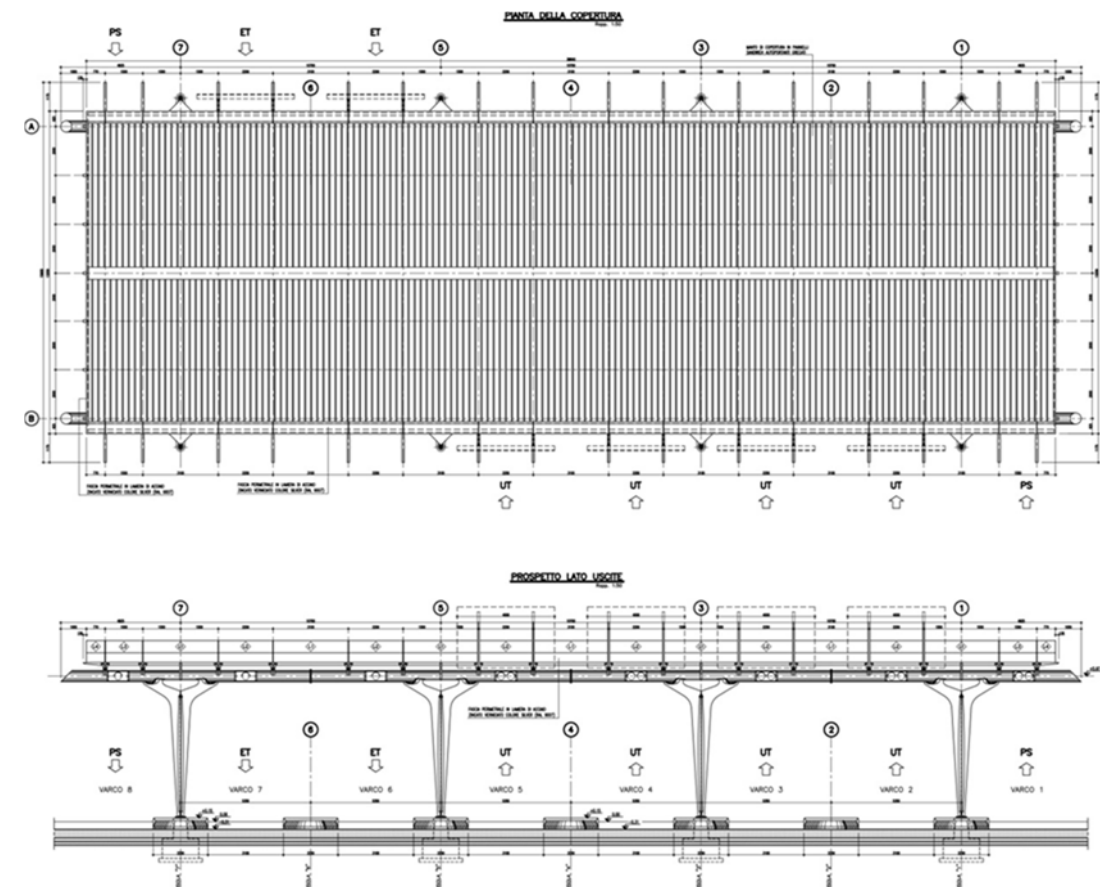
13 Pensilina di stazione - Pianta e prospetto
